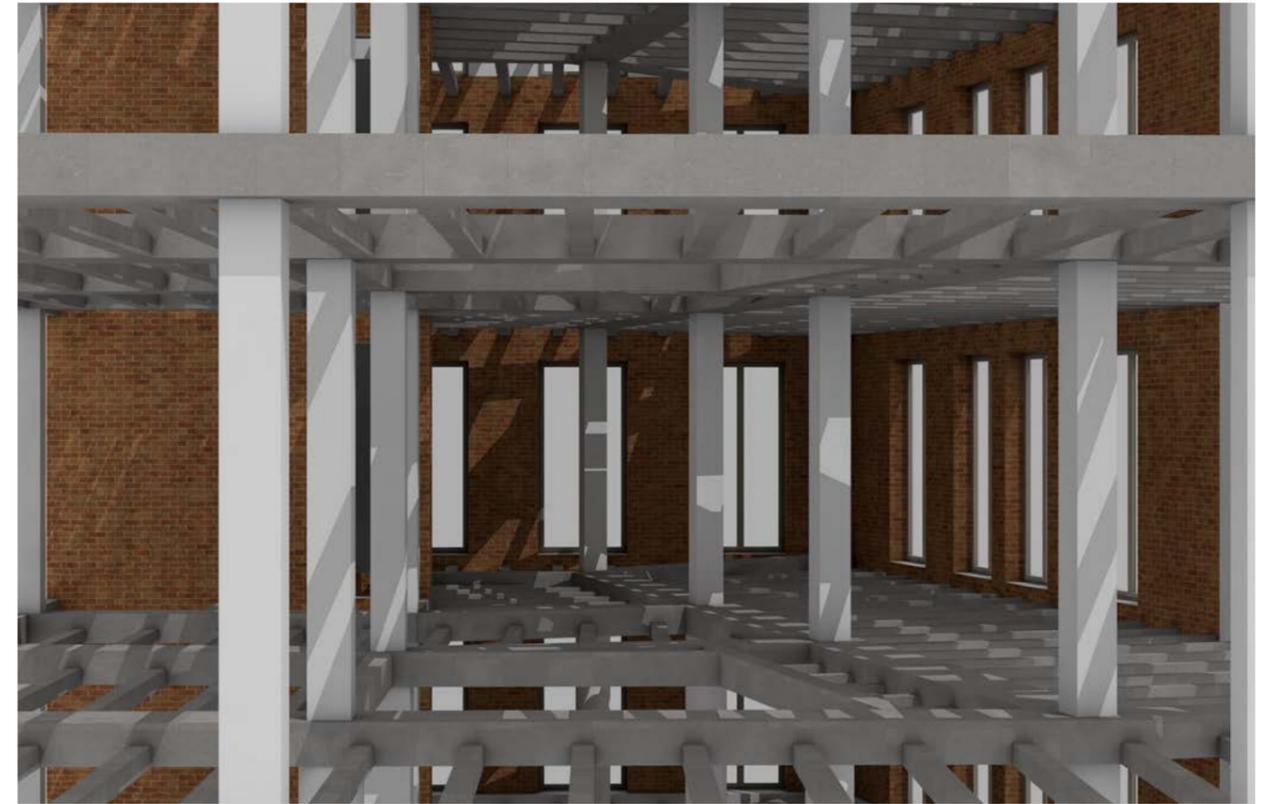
Modelo BIM Archicad. Vista estructura desde patio de luces.
